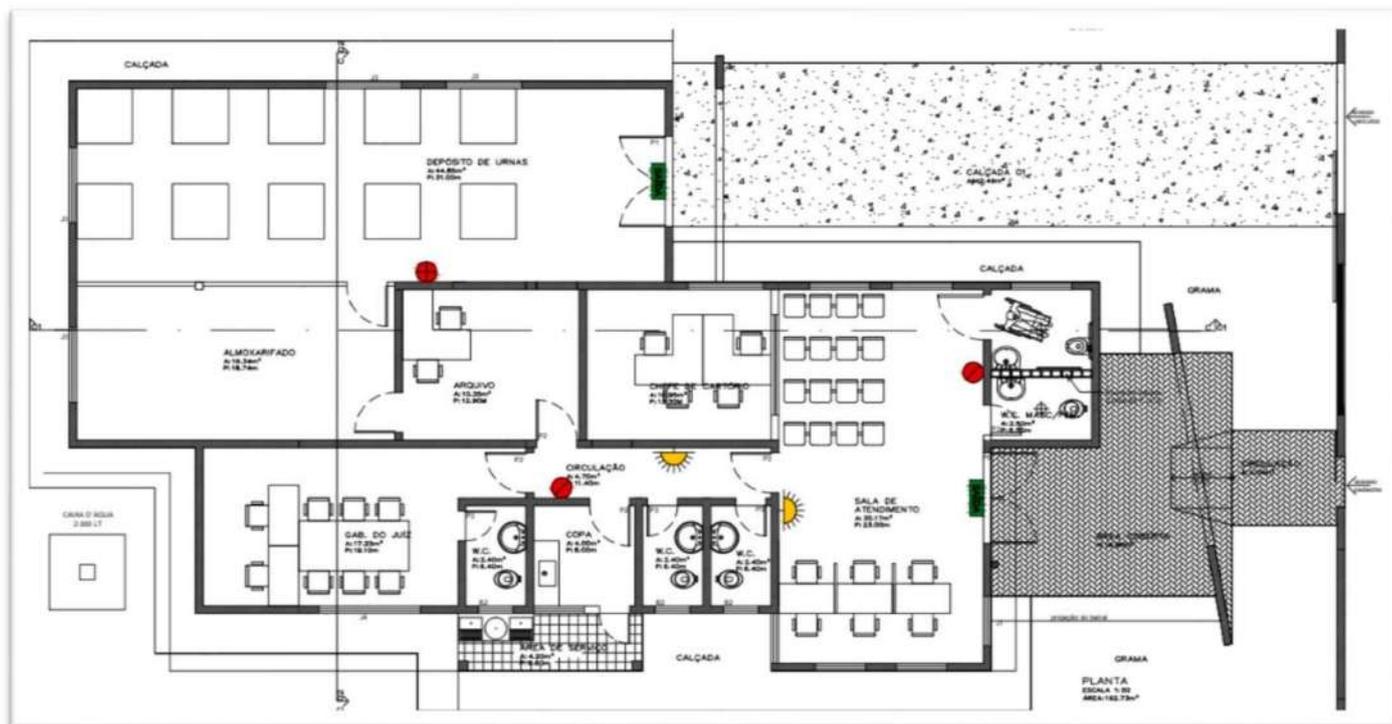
Planta Baixa Fórum (Modelo Padrão 02)
